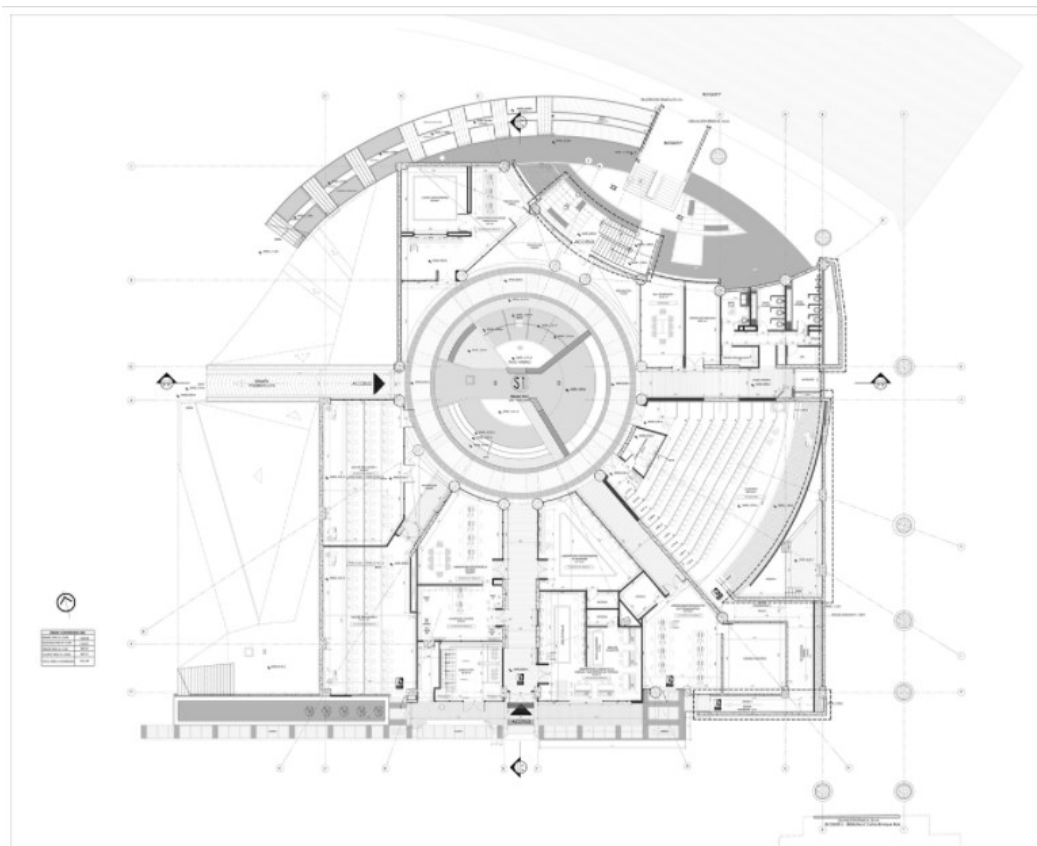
Planta arquitectónica del edificio S1. (ArchDaily, 2019)
